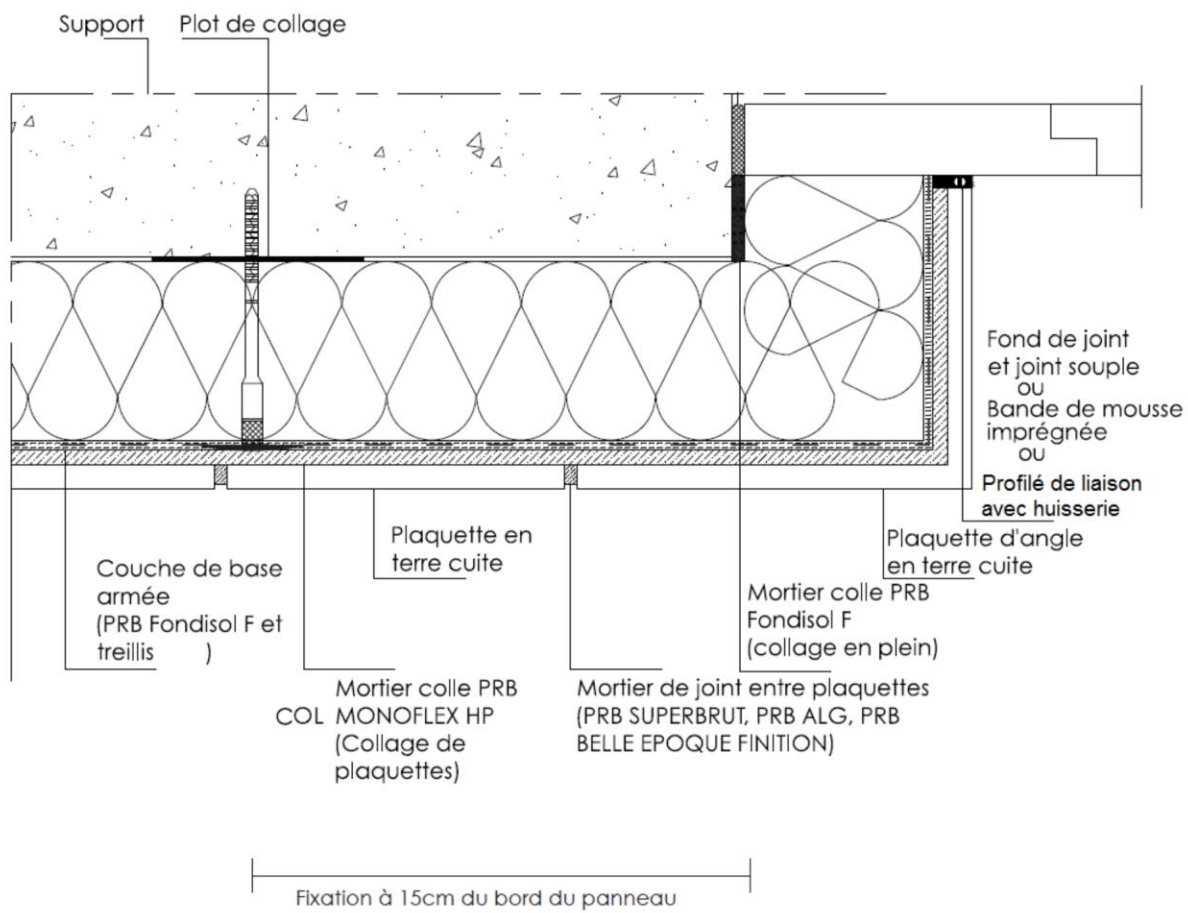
Finition plaquettes de parement en terre cuite : arrêt sur menuiserie
